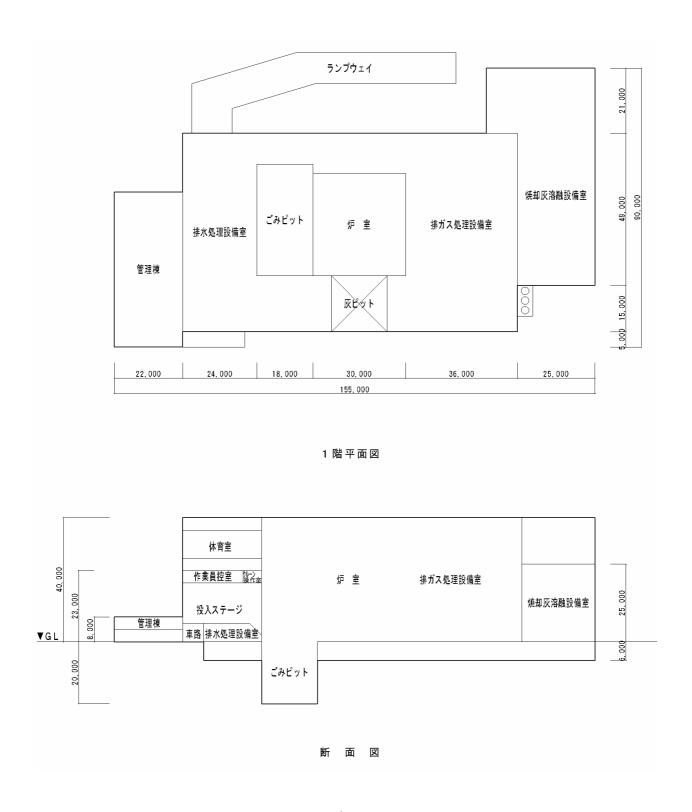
1 階平面図及び断面図 (ストーカ式焼却炉)
